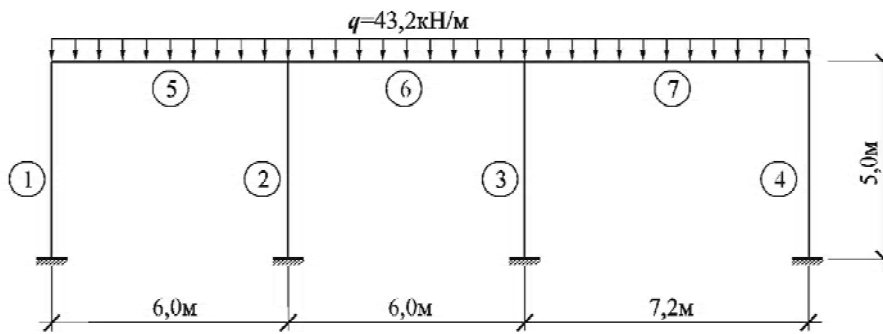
Расчетная схема каркаса здания на первом этапе расчета.
